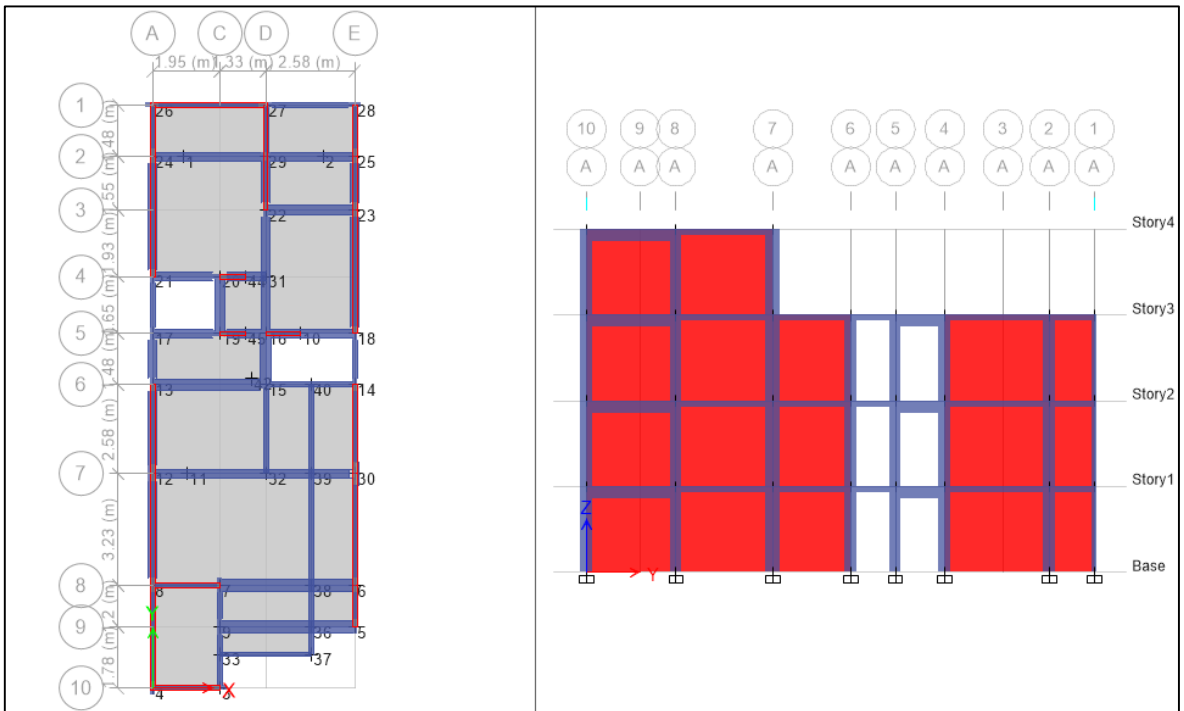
Detalle en elevación y planta del Modelamiento Estructural.
